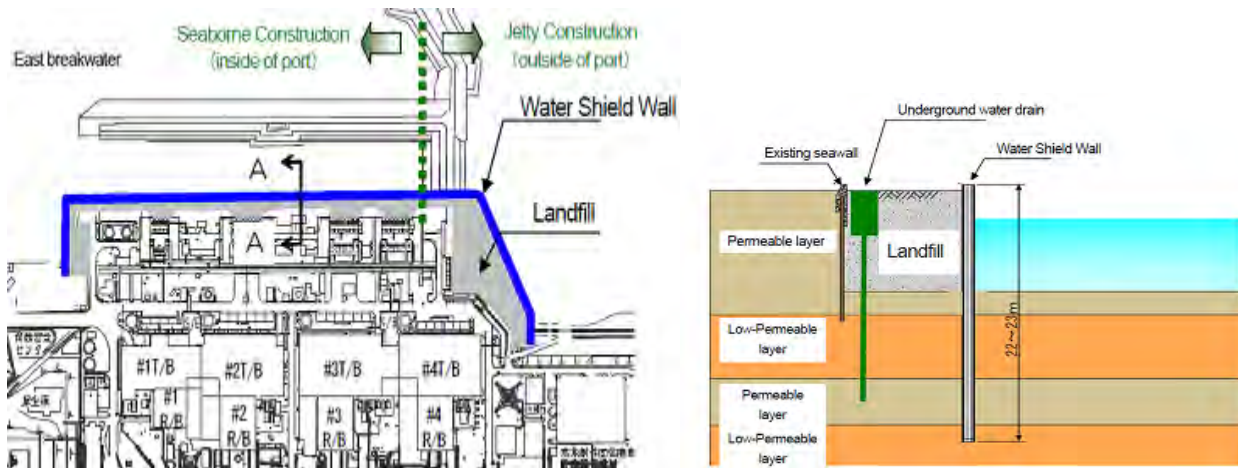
e 8 Perimetro e vista in sezione del nuovo Water Shields Wall
